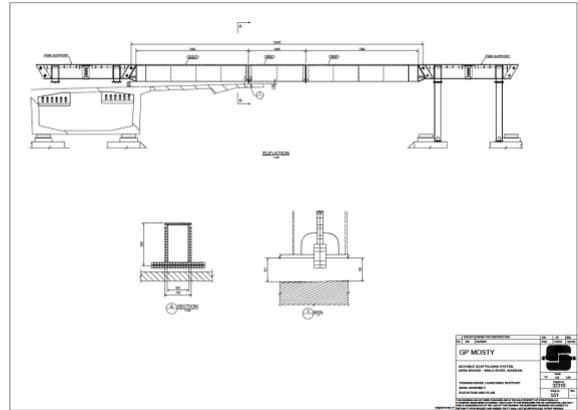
Viga de ripado para paso de la autocimbra al paralelo del viaducto
